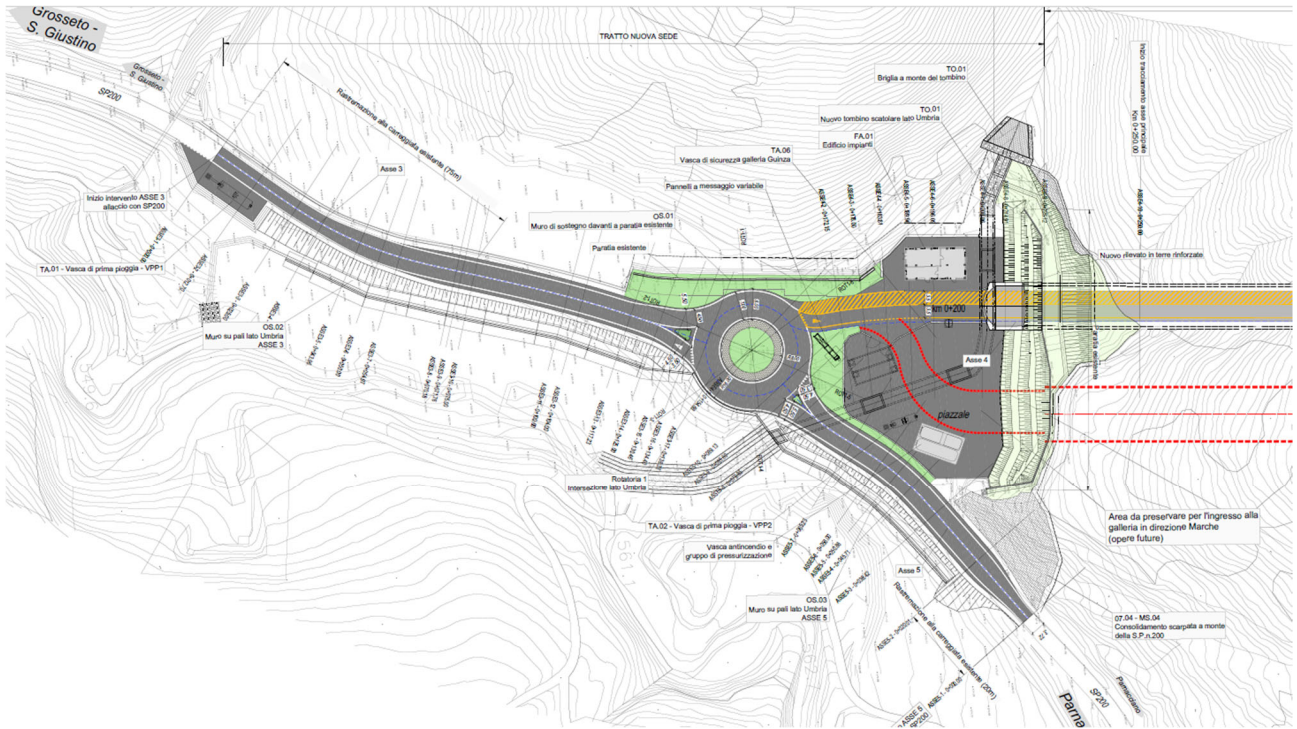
Planimetria dell'intersezione sul lato umbro della Galleria della Guinza (Rotatoria 1).
